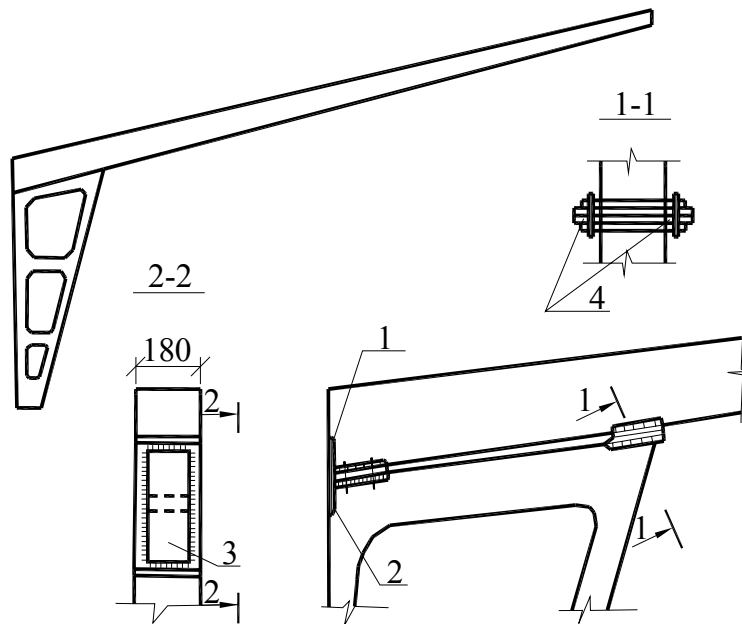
Конструкція вузла з'єднання ригеля зі стійкою піврами:
